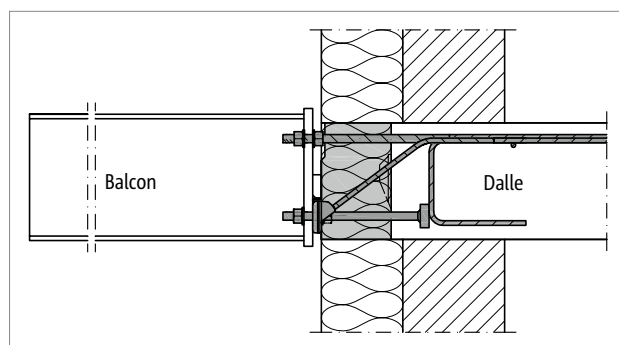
Schöck Isokorb® XT type SK : Le corps isolant affleure le nu extérieur de l'isolation du mur grâce à la saillie de la dalle vers l'extérieur. Ce faisant, les distances aux bords latéraux doivent être respectées
